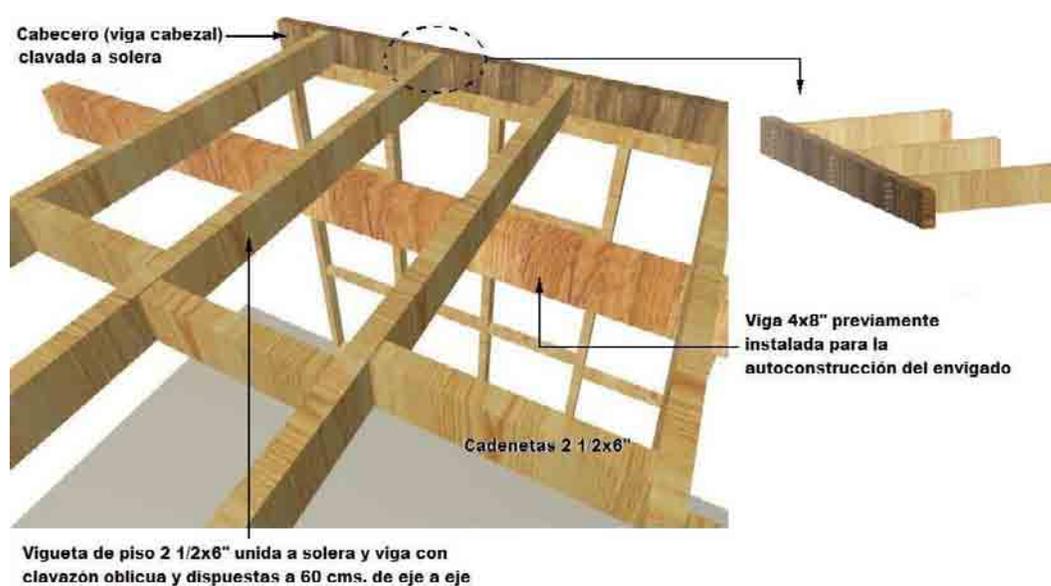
Detalle constructivo para la fijación de las vigas de las casas C, D, E y F del Proyecto Elemental. Fuente: Elaboración propia.
